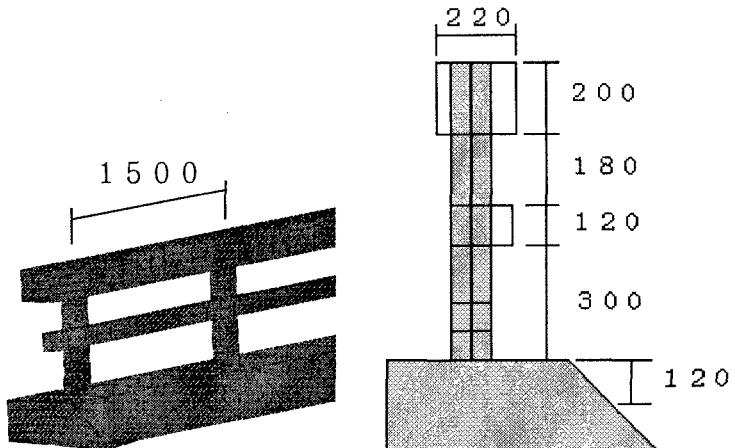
防護柵モデル(単位:mm) 図-2 防護柵断面(単位:mm)
